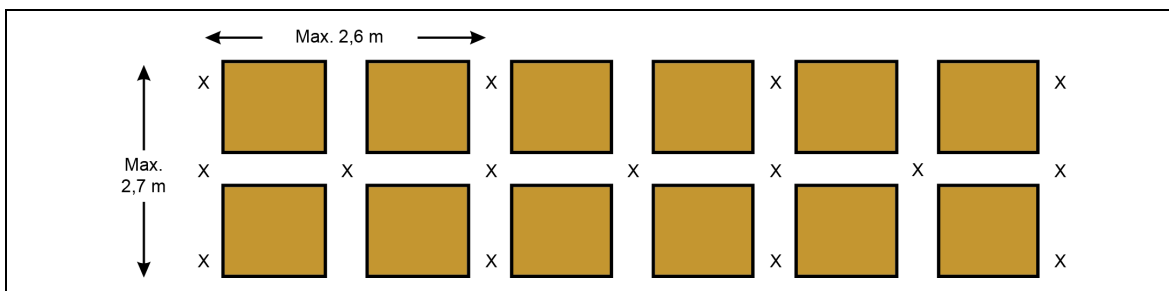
Vue en plan de l'agencement alternatif des sprinkleurs dans des casiers doubles mesurant jusqu'à 2,7 m de profondeur
